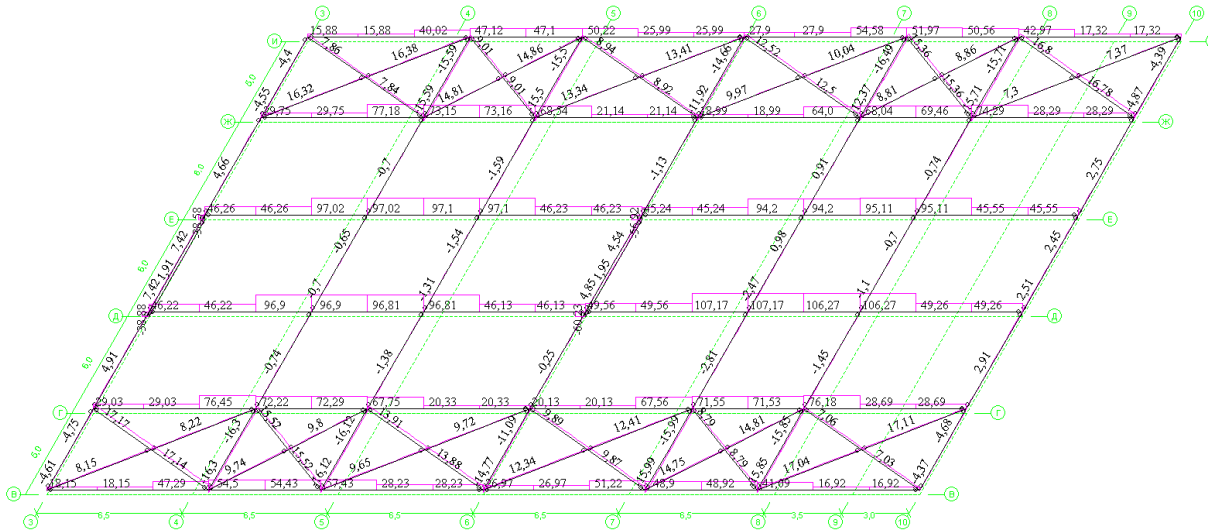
Продольные усилия N по нижнему поясу
